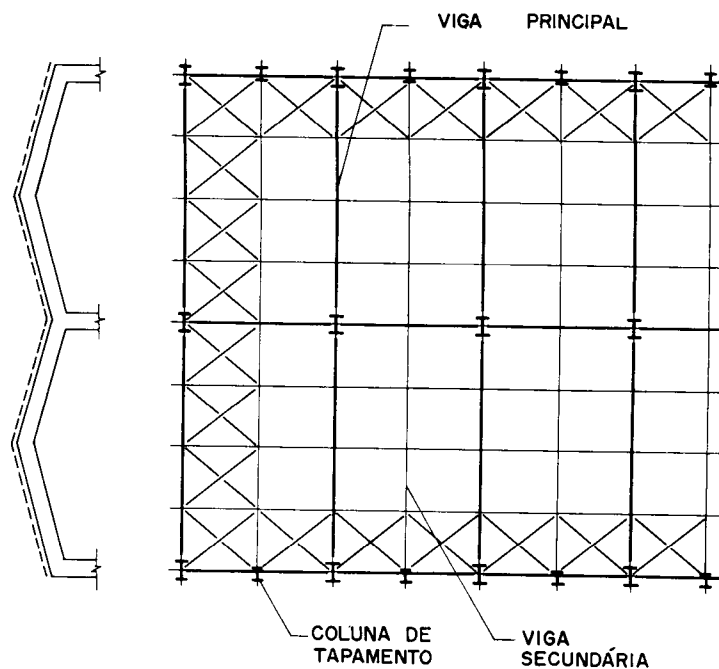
Contraventamentos no plano das terças para edifício industrial aporticado geminado
